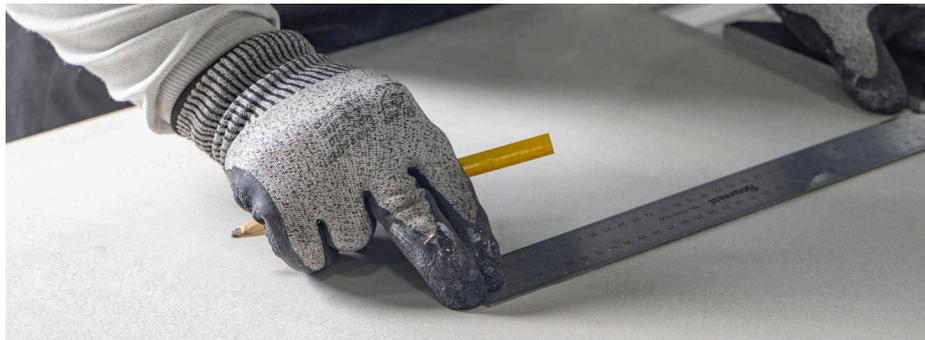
Dibuje en la pieza el corte que se va a realizar.
